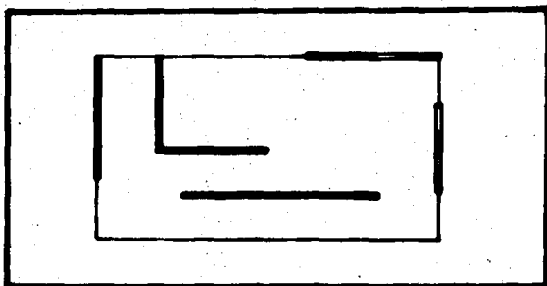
(5) Distribución asimétrica de muros de mampostería.
